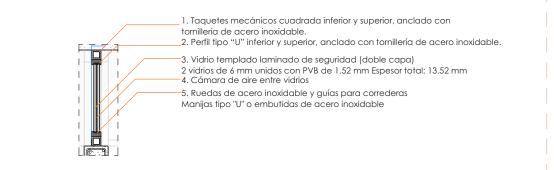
Detalle 09 Corte por muro 3 Fuente: Elaboración propia, 2025 D-09 Detalle CM-03 (1)
